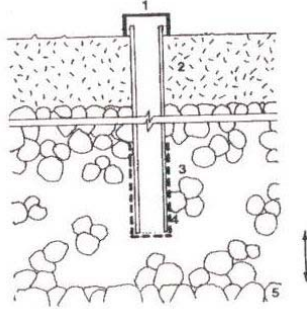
Elementos de un piezómetro. 1.- Tapa, 2.- Cubierta del pozo, 3.- Relleno, 4.- Geotextil, 5.- Fondo del pozo.
